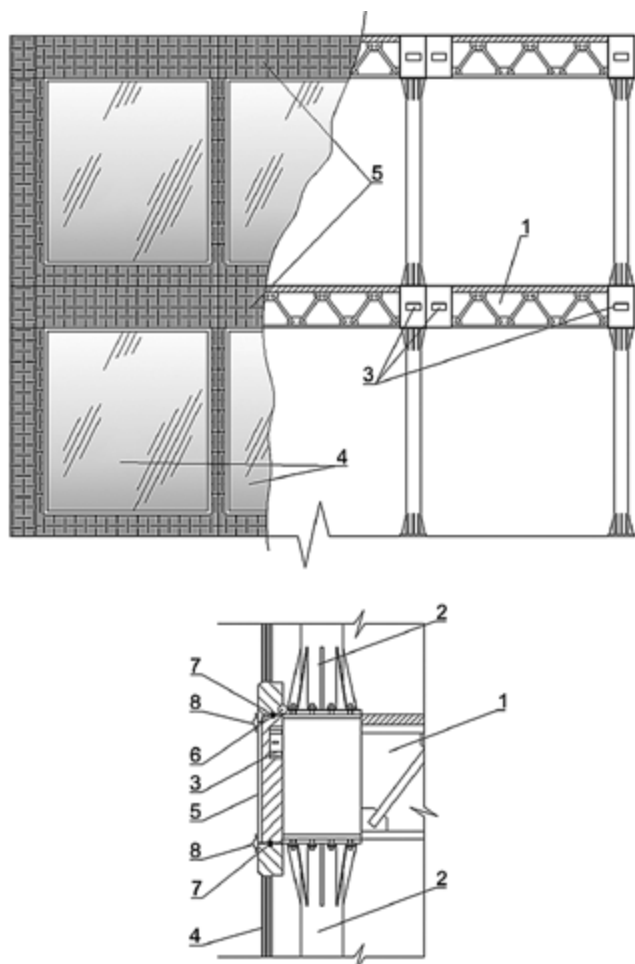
Пример крепления фасадной панели: 1 – модуль перекрытия; 2 – колонна; 3 – дополнительные крепежи для наружных стеновых ограждений; 4 – двухкамерный стеклопакет; 5 – простенки с солнечными батареями; 6 – поворотные петли стенового ограждения; 7 – уплотнитель стыка; 8 – нащельник
